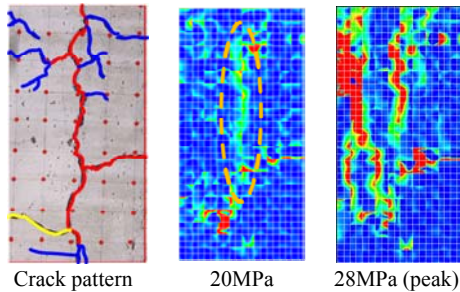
ASRによってひび割れが生じたコンクリート供試体の圧縮応力下のひび割れ進展
